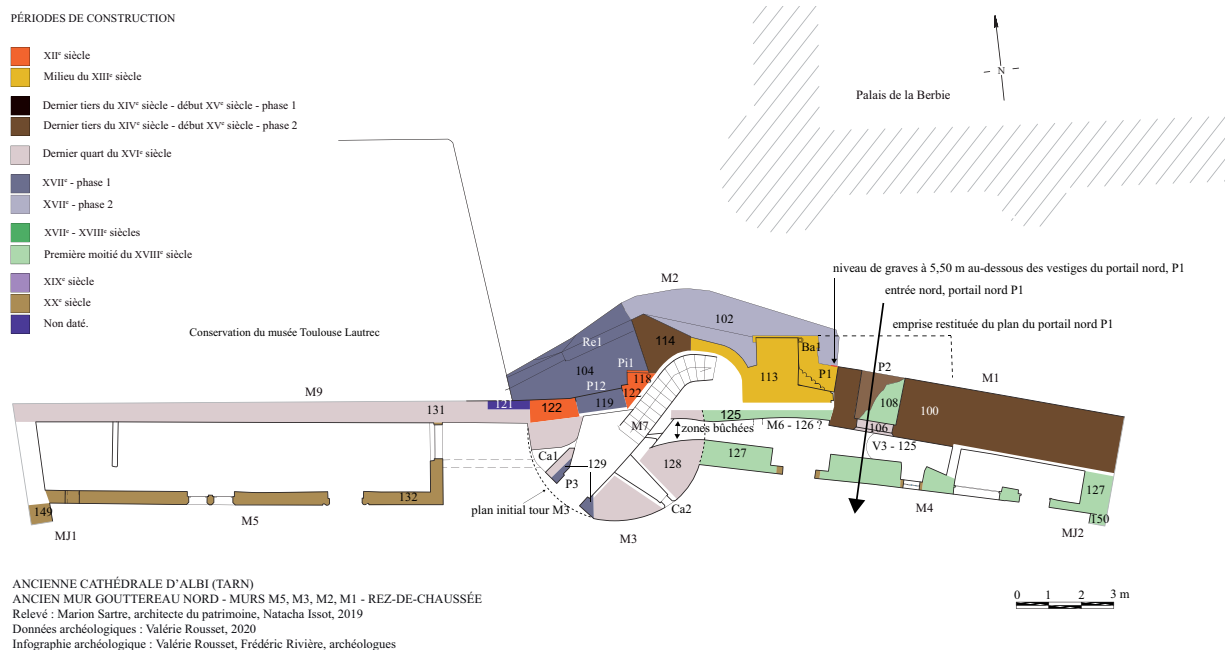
ANCIENNE CATHÉDRALE D'ALBI. Ancien mur gouttereau nord. Plan du rez-de-chaussée.
